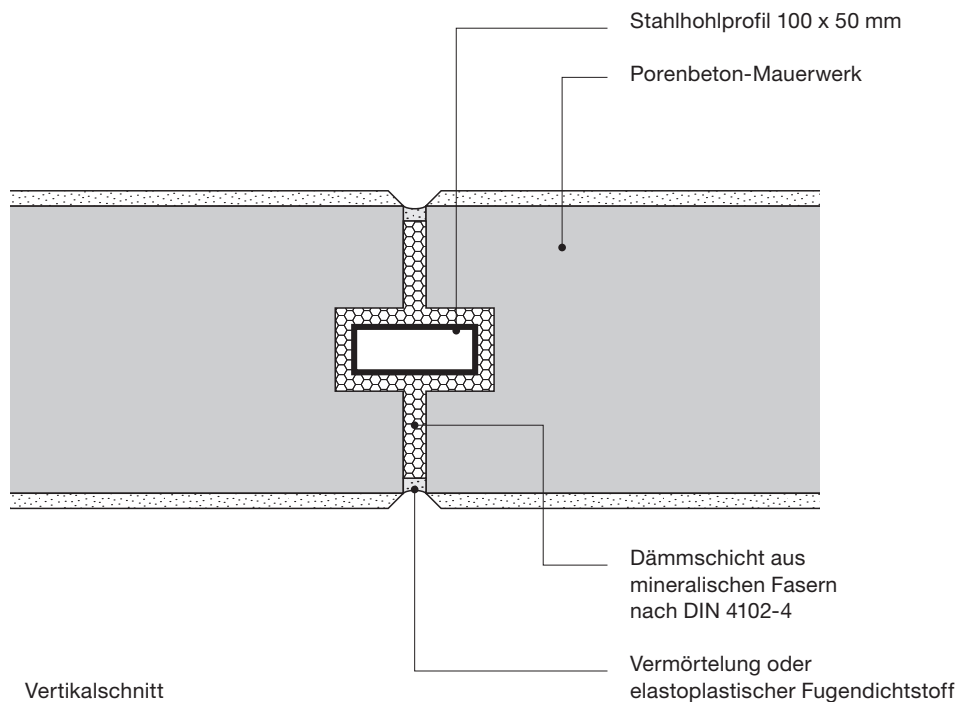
Fugenausbildung mit Aussteifung für Porenbetonmauerwerk mit F-Klassifizierung
